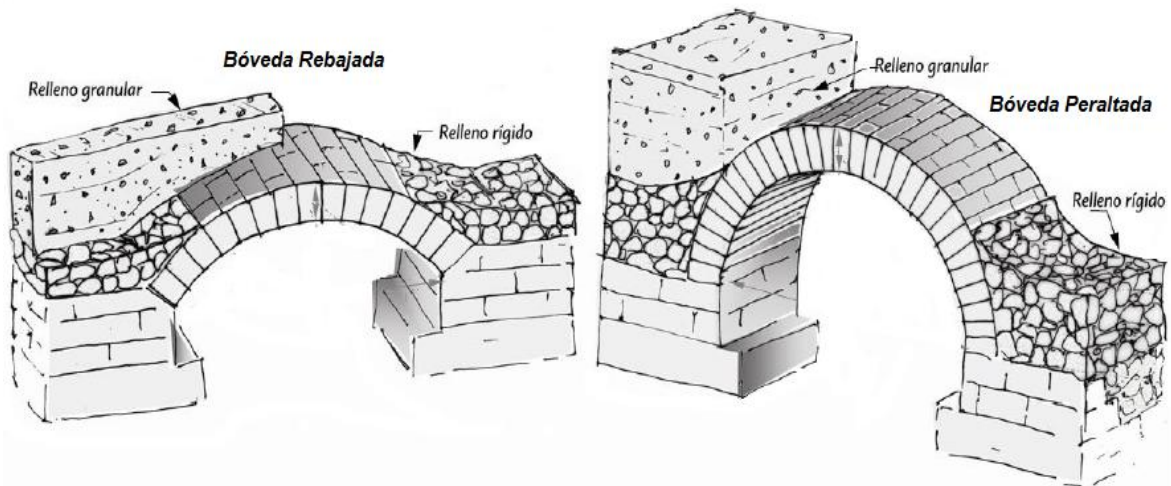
Esquema de la composición de los rellenos en un puente de mampostería con bóveda de arco.
